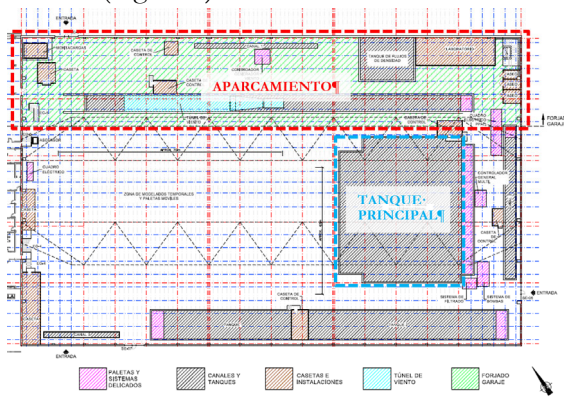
Planta de instalaciones en nivel principal y niveles inferiores.
